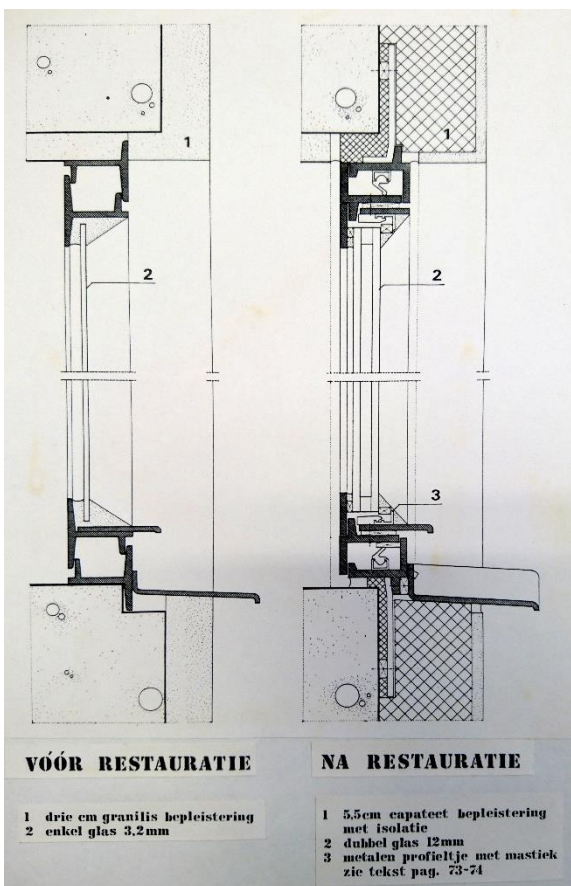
Detalle constructivo de las carpinterías antes y después de la restauración.
